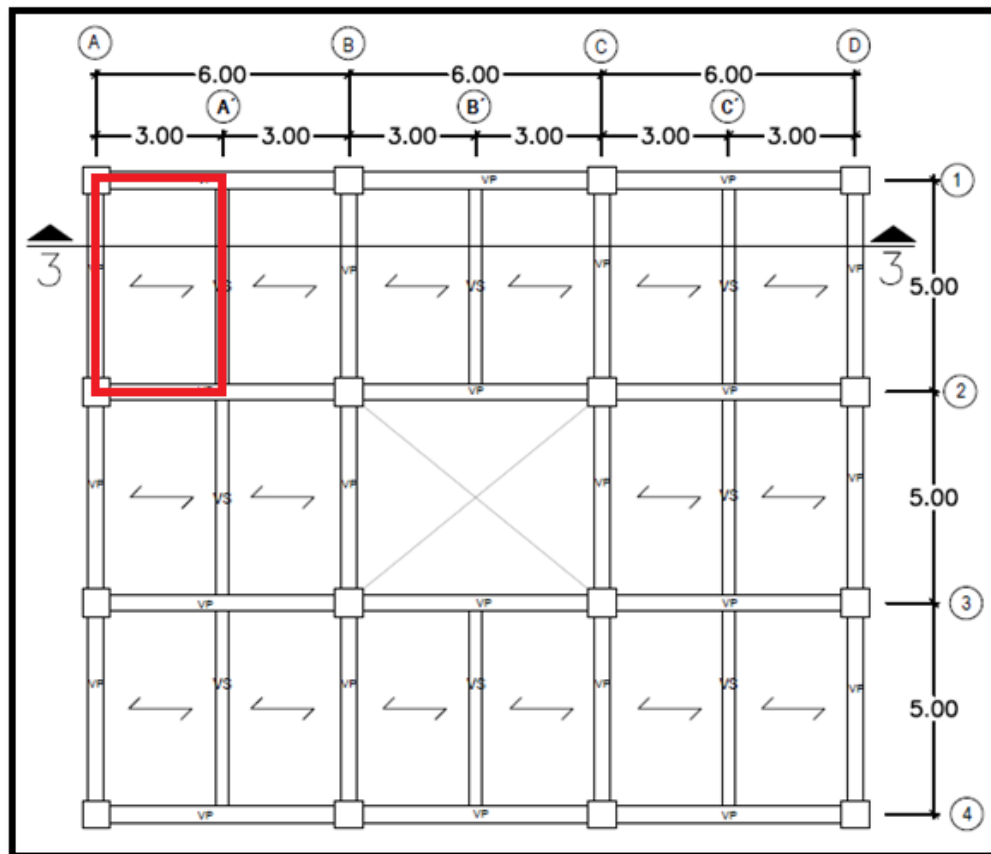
Área a considerar para presupuesto de losa acero GALVADECK.
